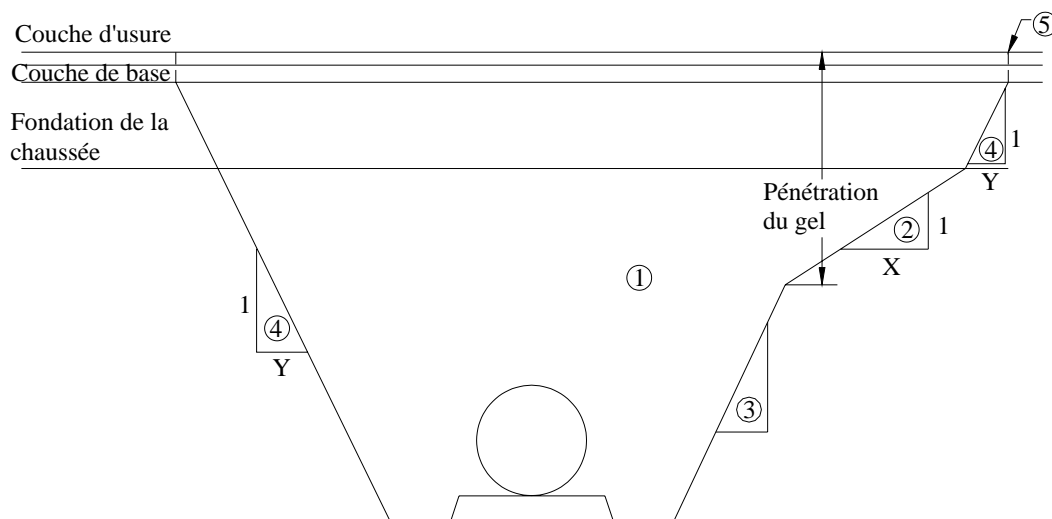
Schéma type d'une tranchée et de son remblayage en terrain instable
